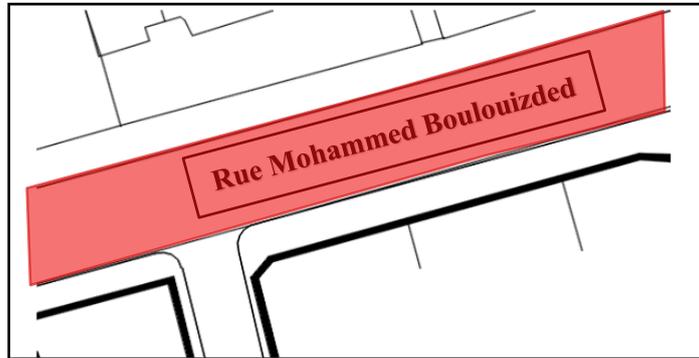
vue en plan de la rue Mohammed Belouizded avant l'intervention
